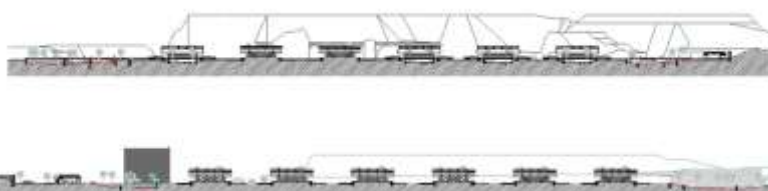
Secciones transversales del proyecto; Fuente: Equipo consultor arquitectónico
